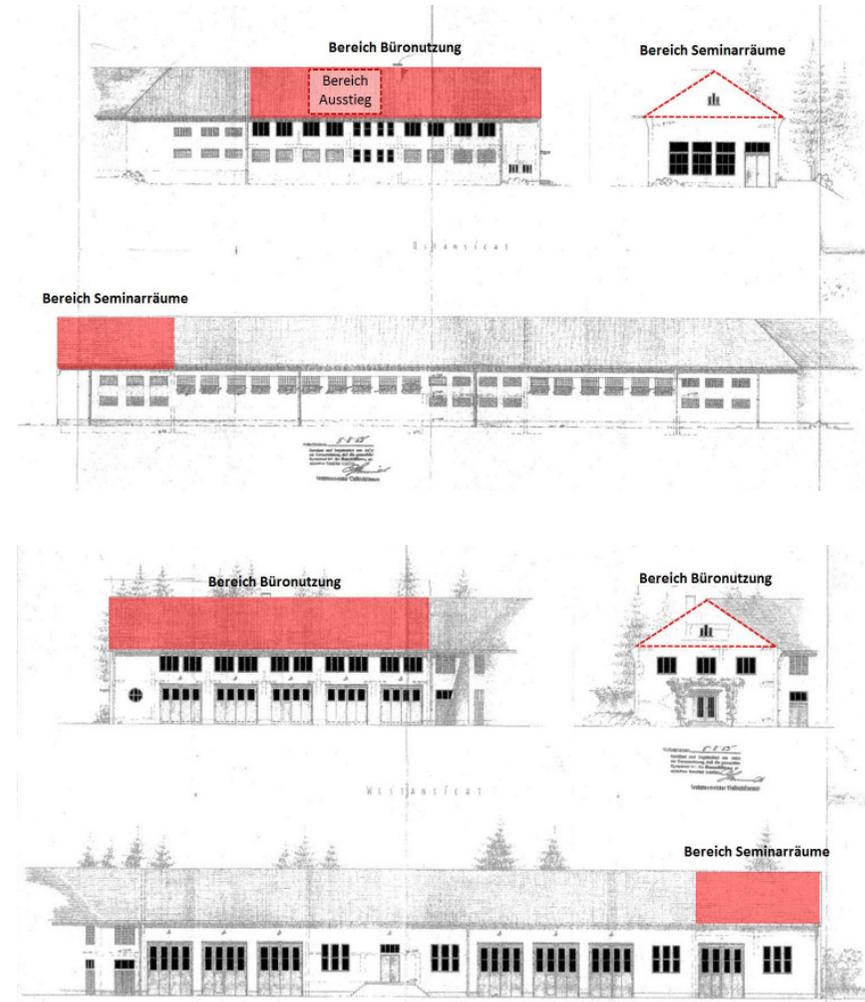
/4: Kennzeichnung zur Erneuerung berücksichtigter Dachflächen
